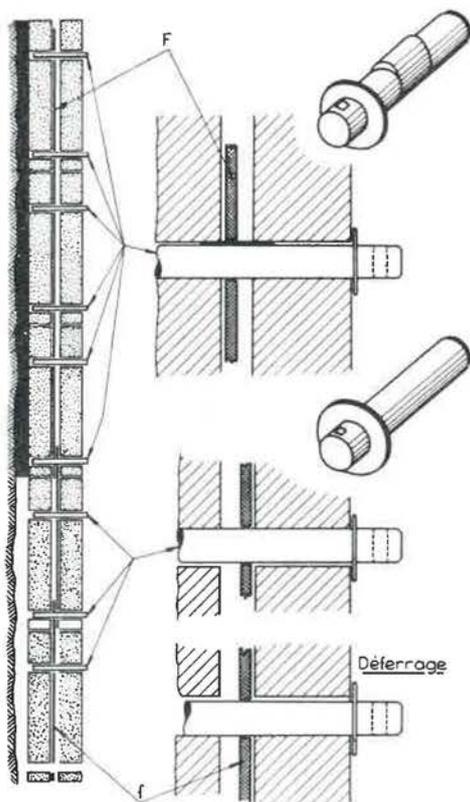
Broches à came, pour faciliter la reprise des plats de suspension après le bétonnage.
